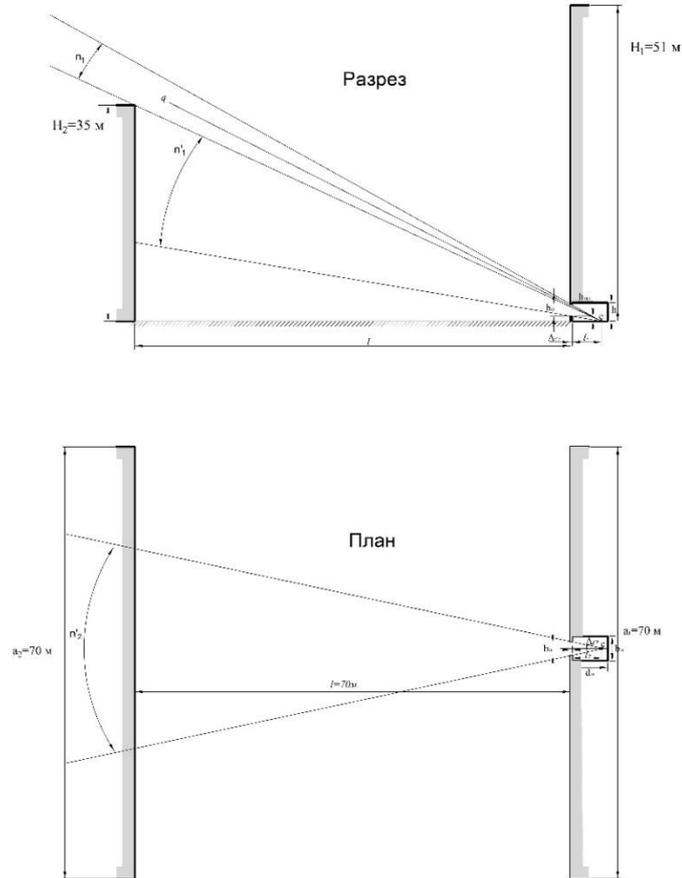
Разрез и план с видимыми из расчетной точки помещения участков фасада противостоящего здания и открытого небосвода
